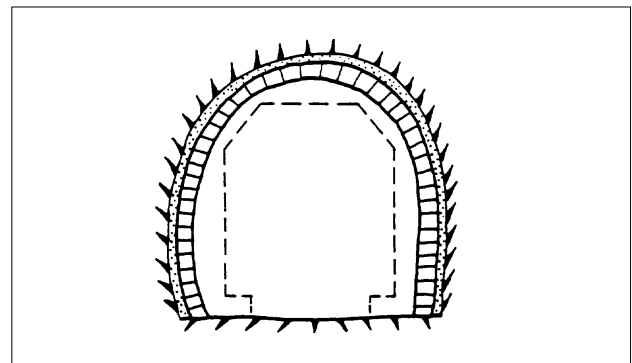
Bahntunnel mit Auskleidung aus Natursteinmauerwerk:
